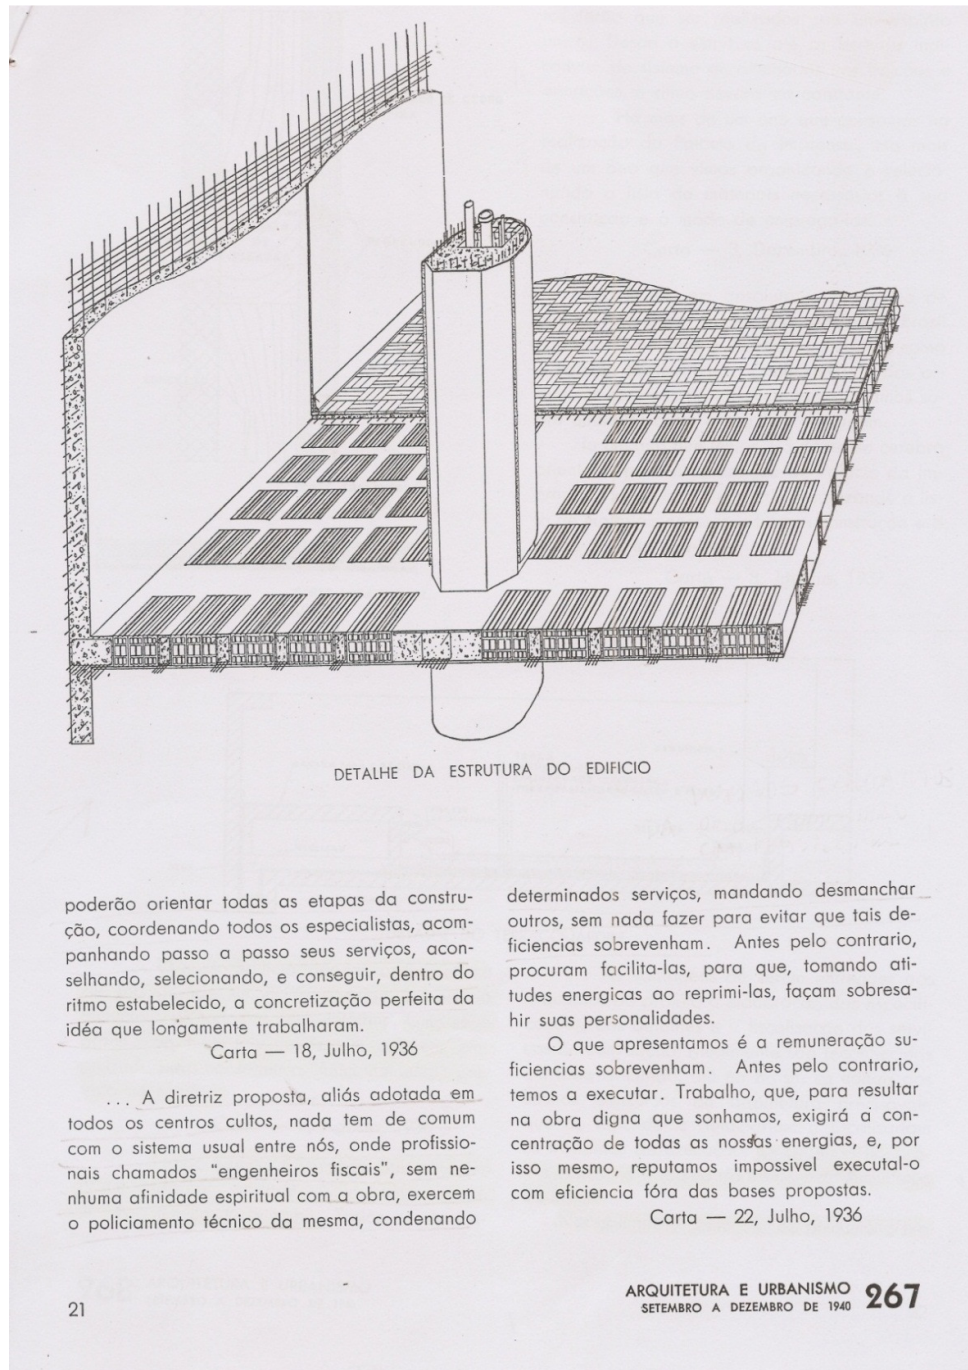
L – Detalhamento perspectivado publicado na Revista Arquitetura e Urbanismo, em 1940
